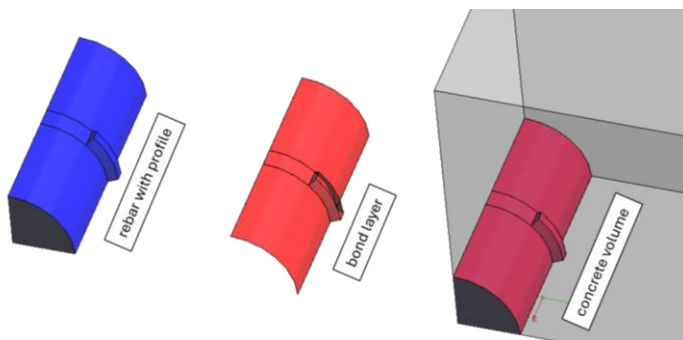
3D-FE-Modell eines profilierten Bewehrungsstabes in Beton
